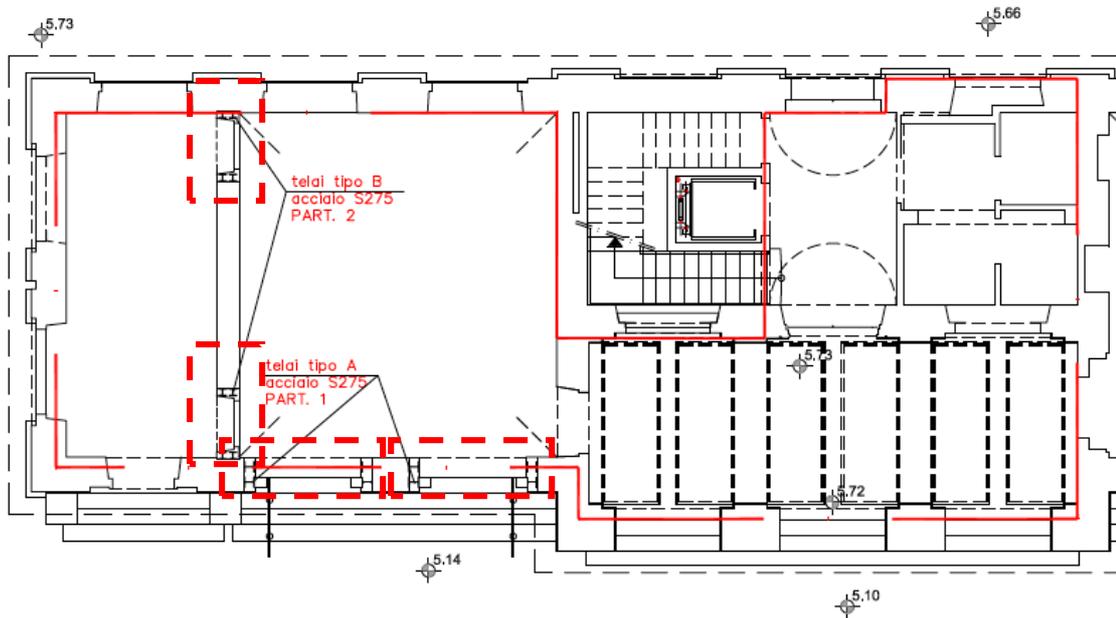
Pianta Piano Terra – Localizzazione degli interventi
